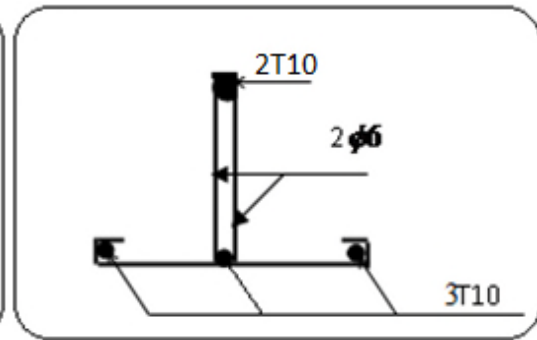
Schéma de ferrailage de la poutrelle type2.
